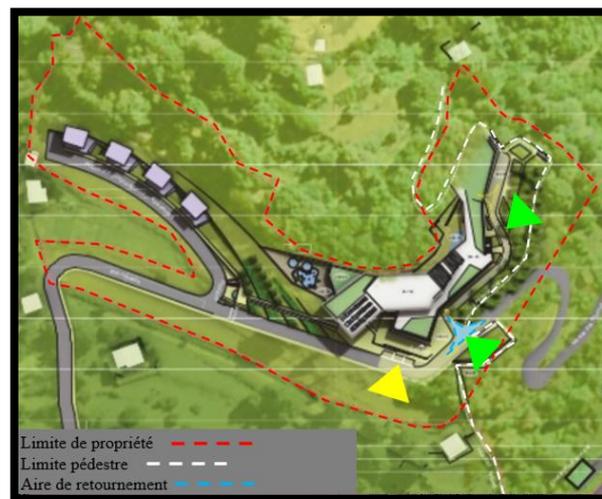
plan de masse, source: <https://www.slideshare.net/>
